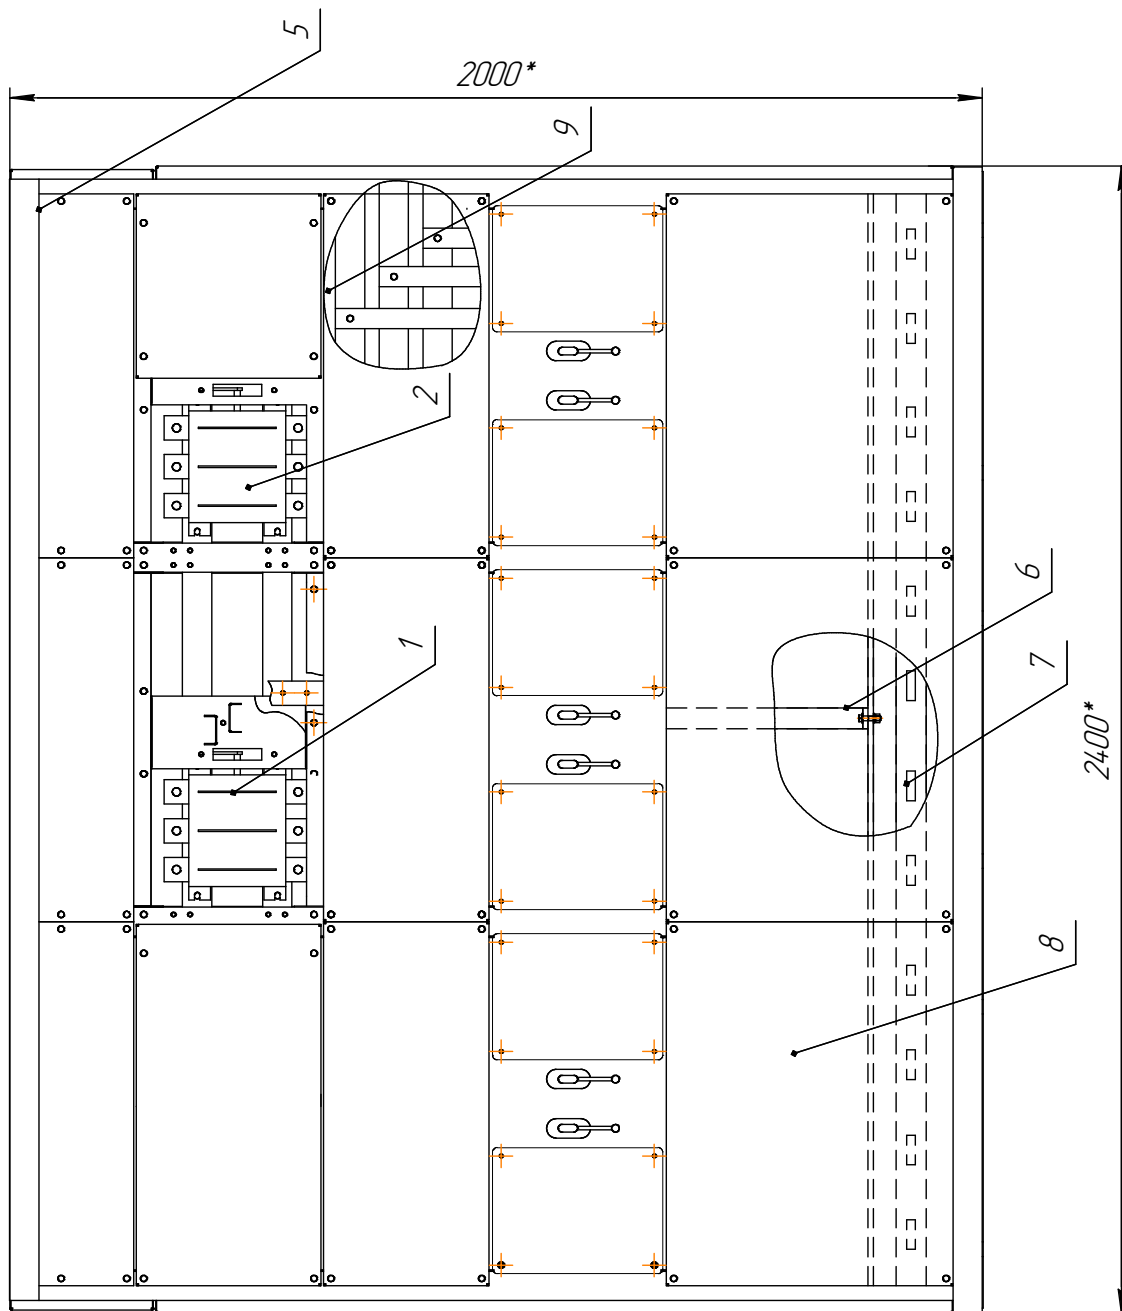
Установка модуля электротехнических блоков на фундамент
